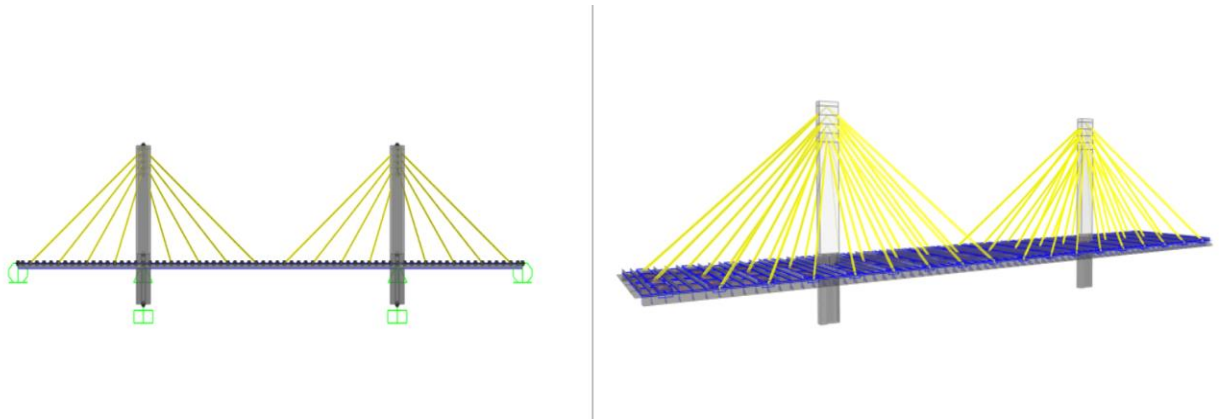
Modelo estructural del puente, desarrollado en SAP-2000
